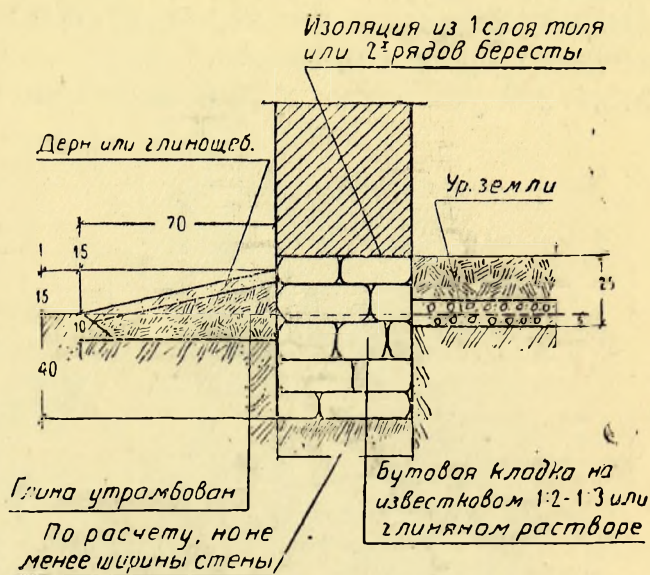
Сплошной фундамент в непучащихся грунтах.
